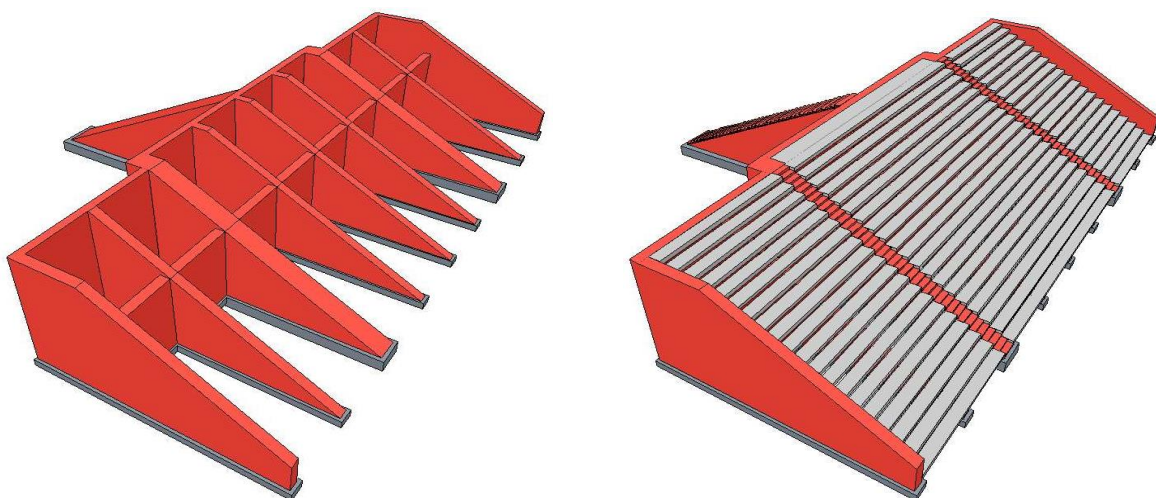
Längstribüne Grundkonstruktion (links), mit Deckschicht (rechts)
